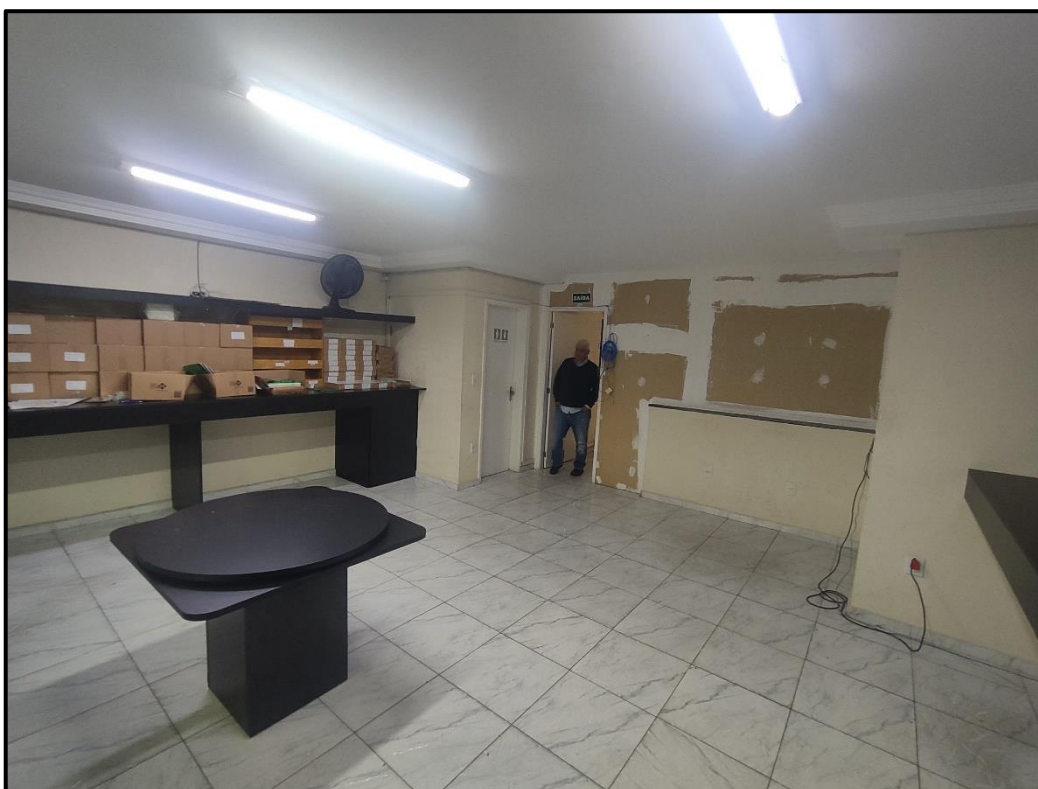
1º pavimento (1º andar) – Banheiro
